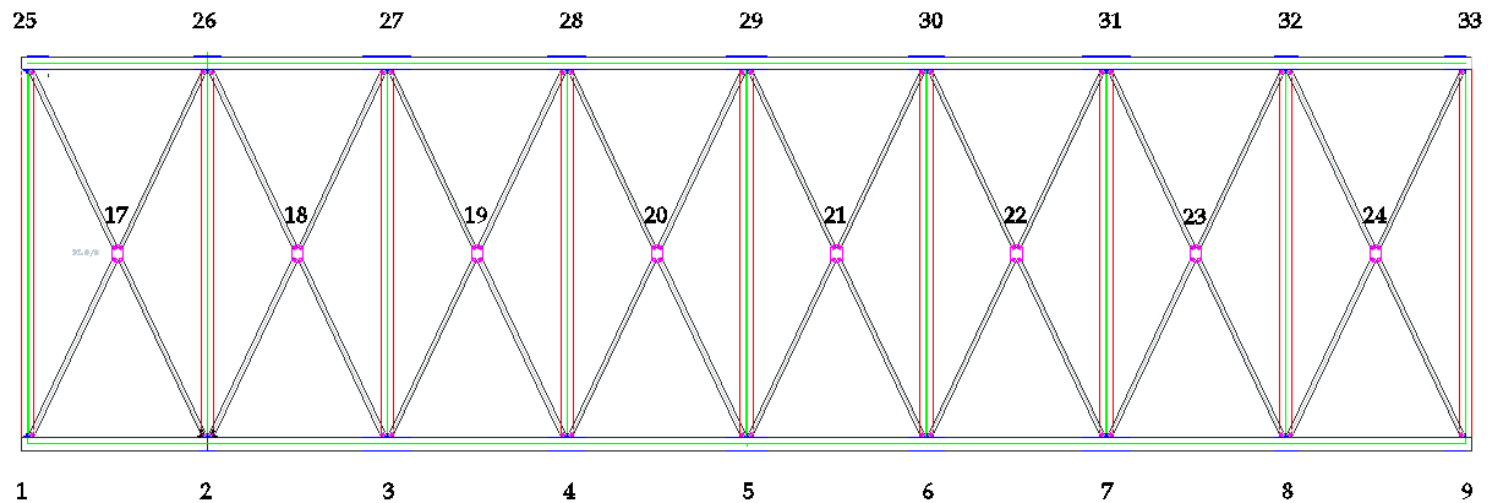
VISTA EN PLANTA DE LA BASE
